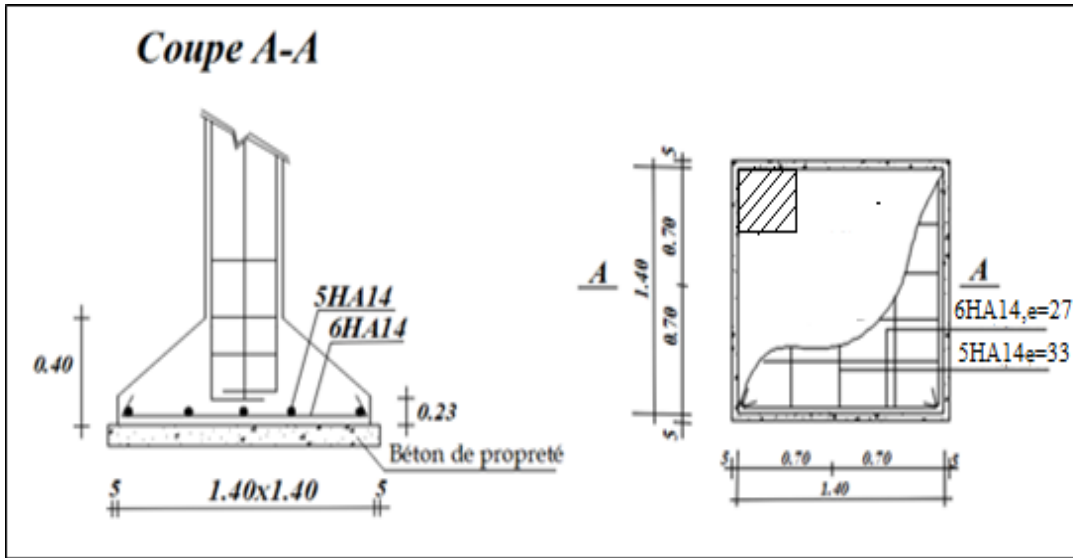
Exemple de ferrailage d'une semelle d'angle sous poteau.
